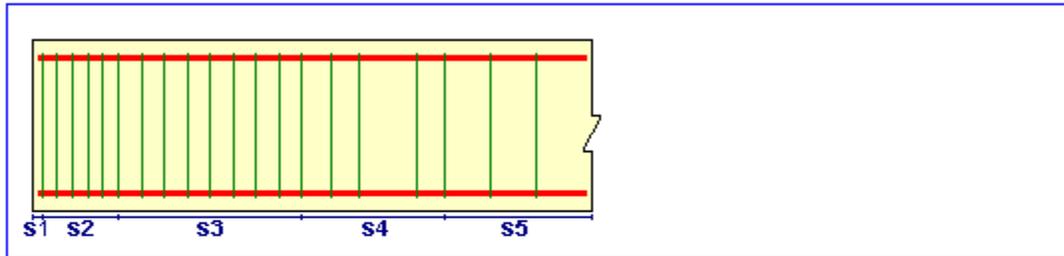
Vista del Reporte del Diseño de Viga con Concreto Reforzado, Hoja 1/2.
